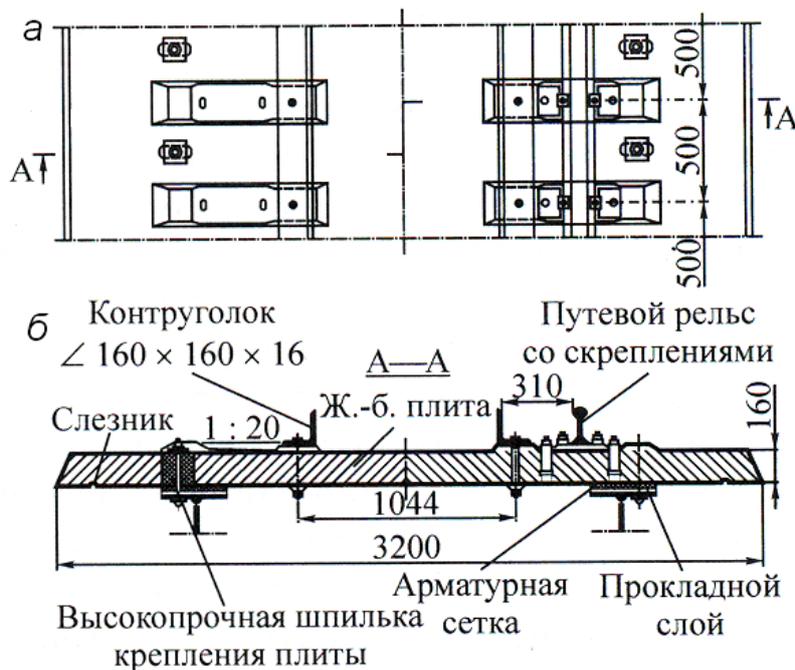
Конструкция мостового полотна на без балластной железобетонной плите: а – план; б – поперечное сечение
